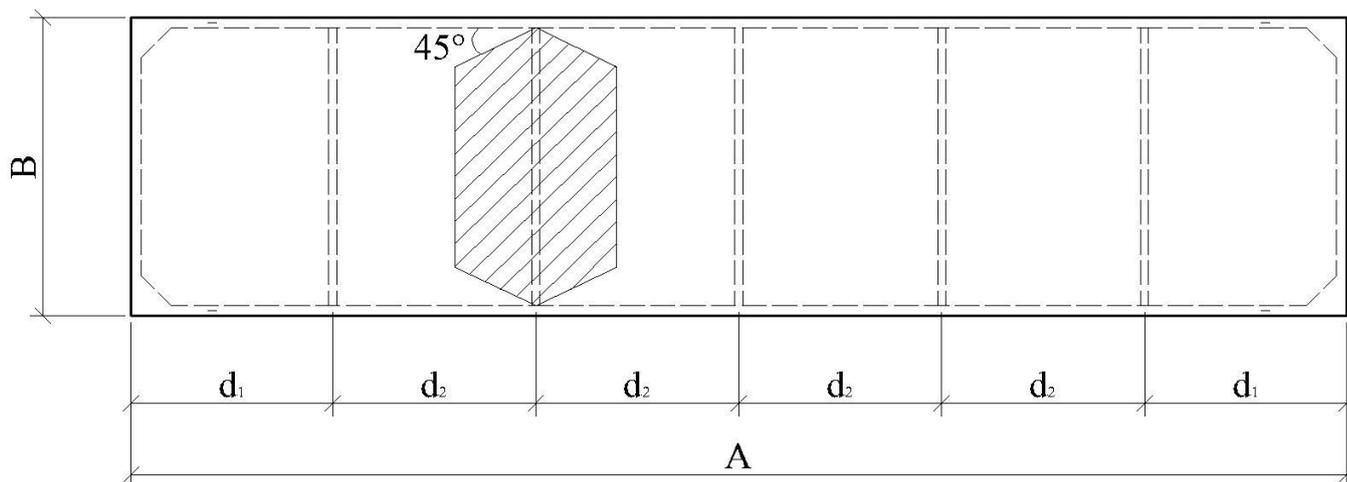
Расчетная площадь поперечного ребра ребристой панели перекрытия
